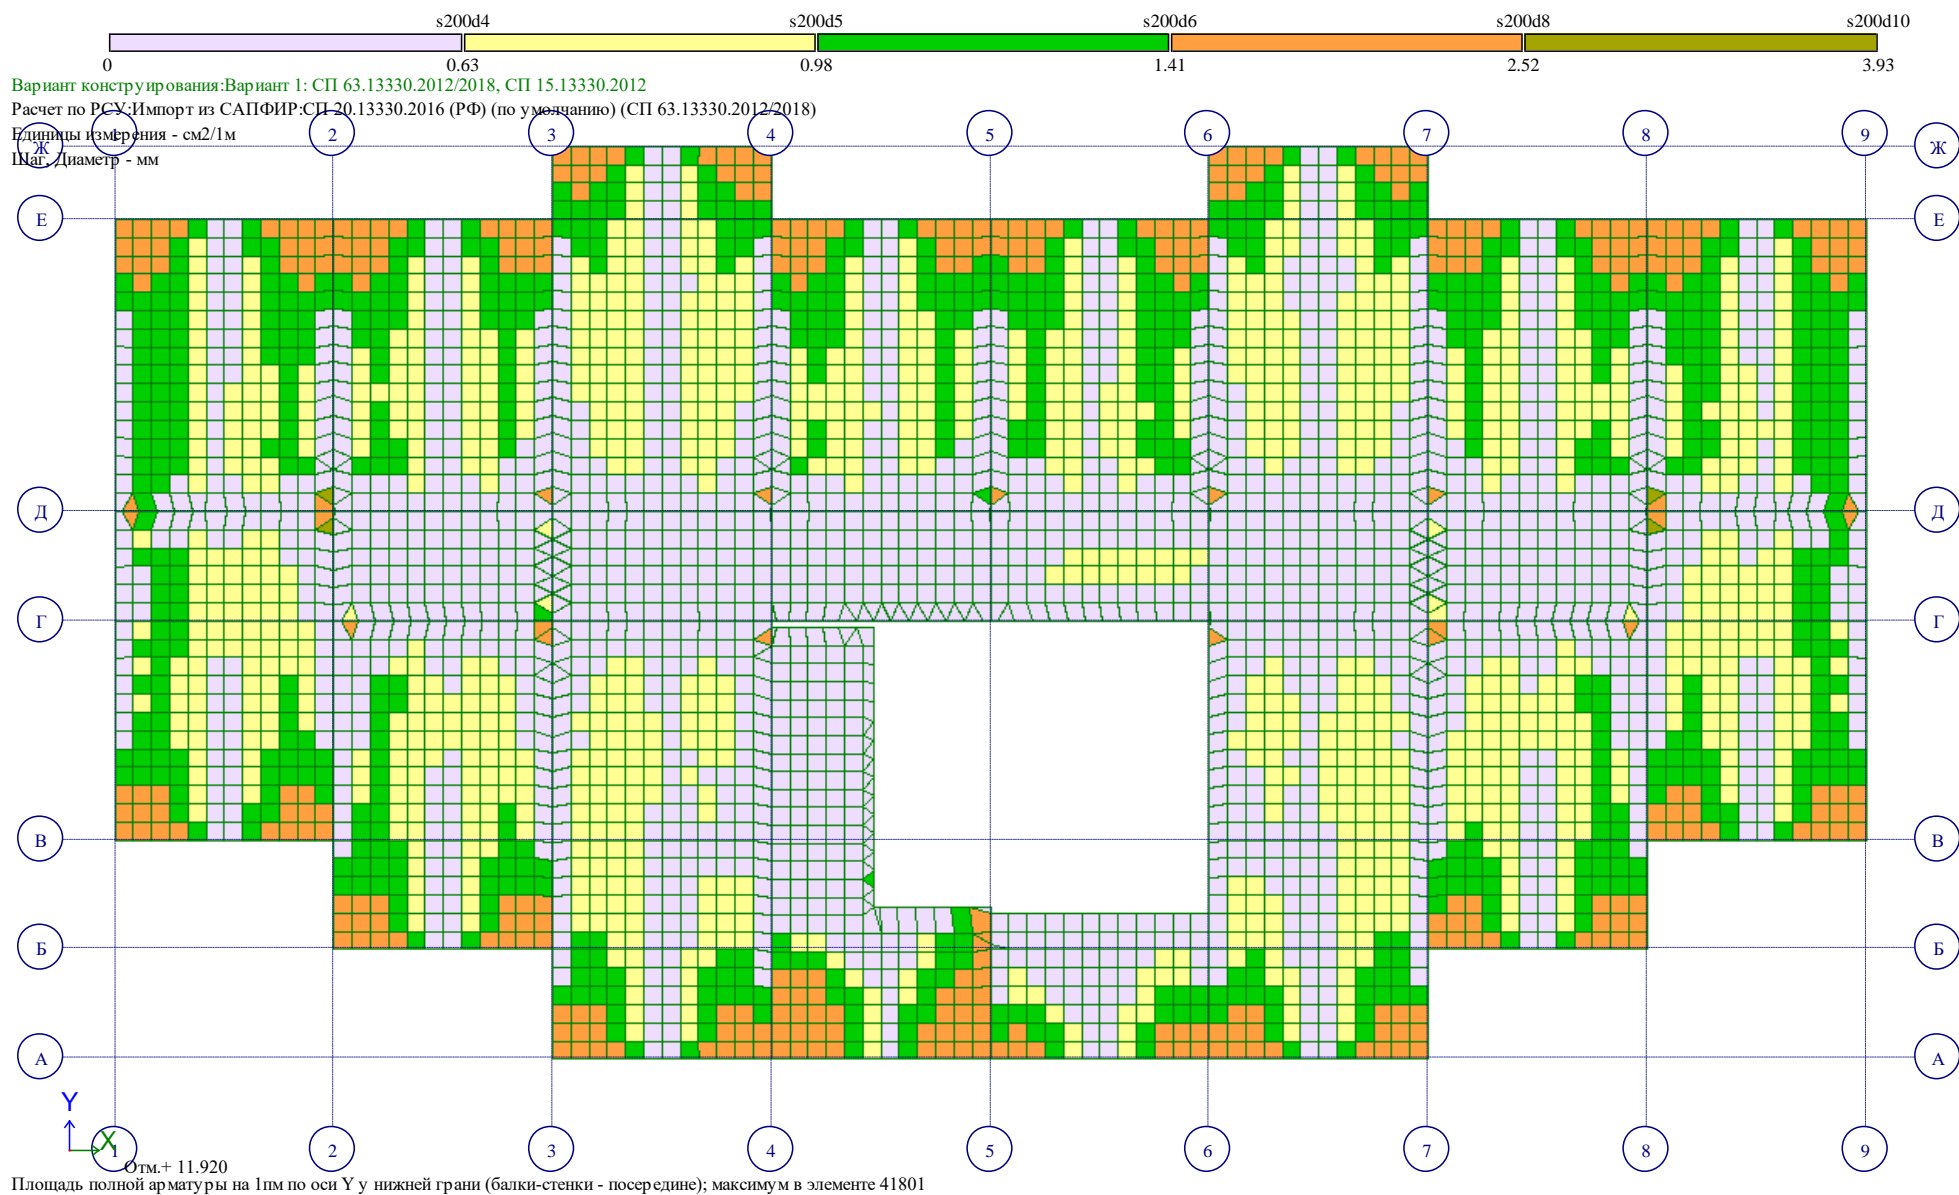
Площадь полной арматуры на 1мм по оси Y у нижней грани
